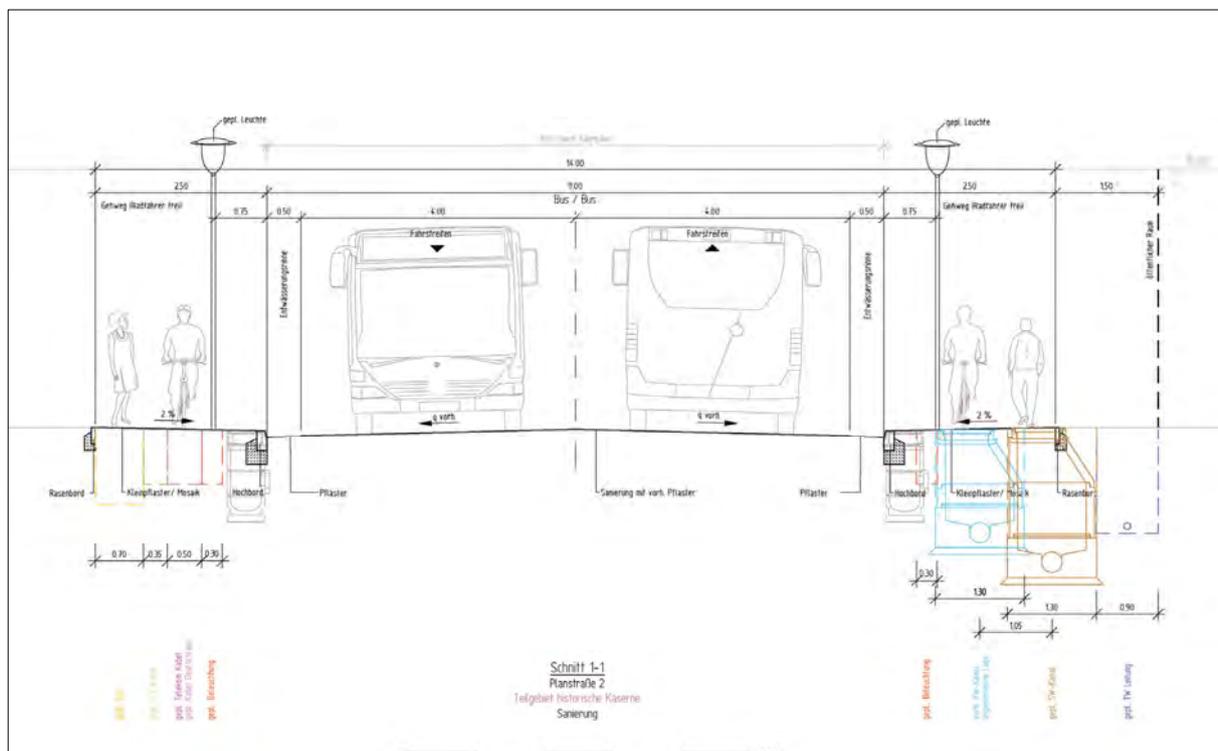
Erschließung, Straßenquerschnitt 1-1; Planstraße 2
